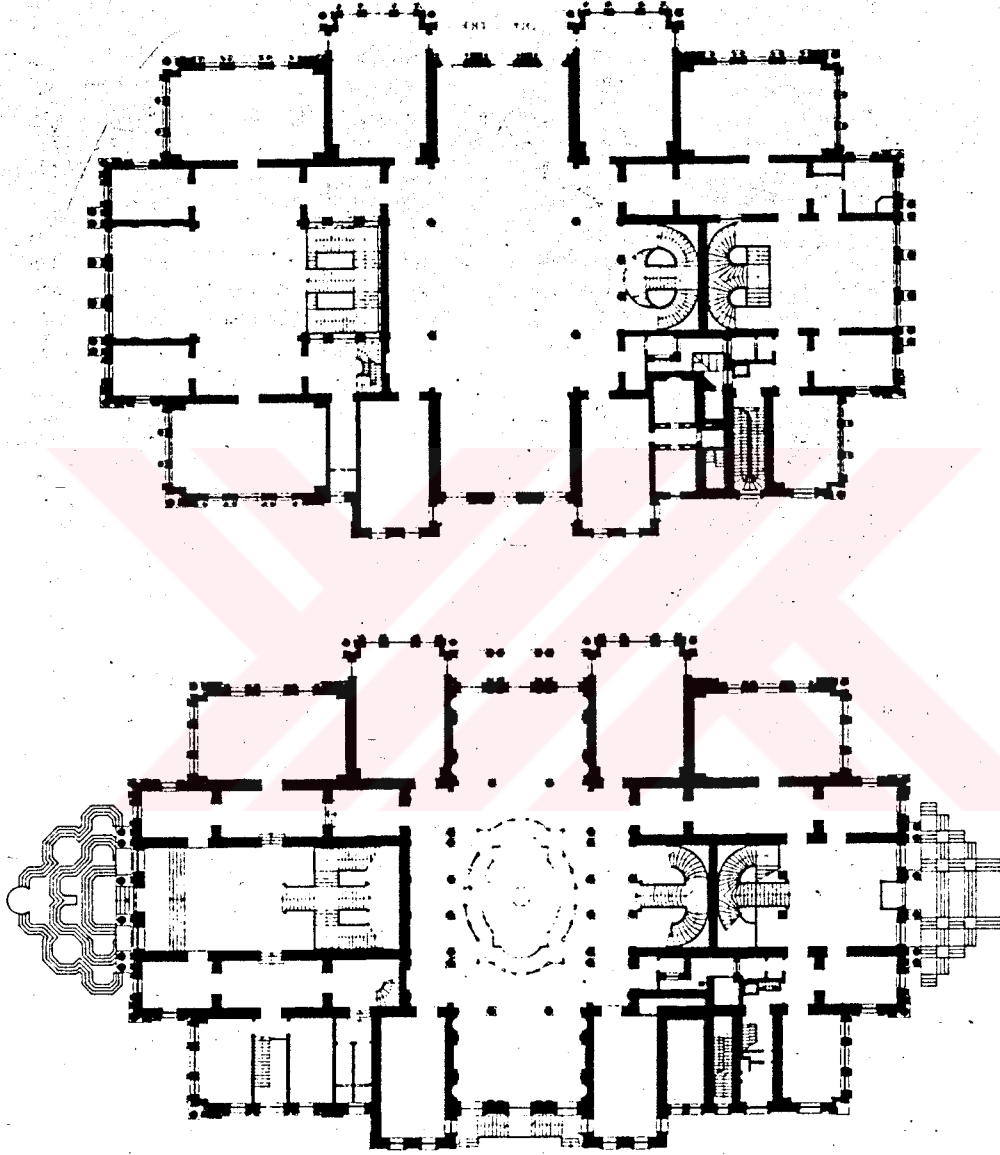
Beylerbeyi Sarayı Vaziyet Planı
